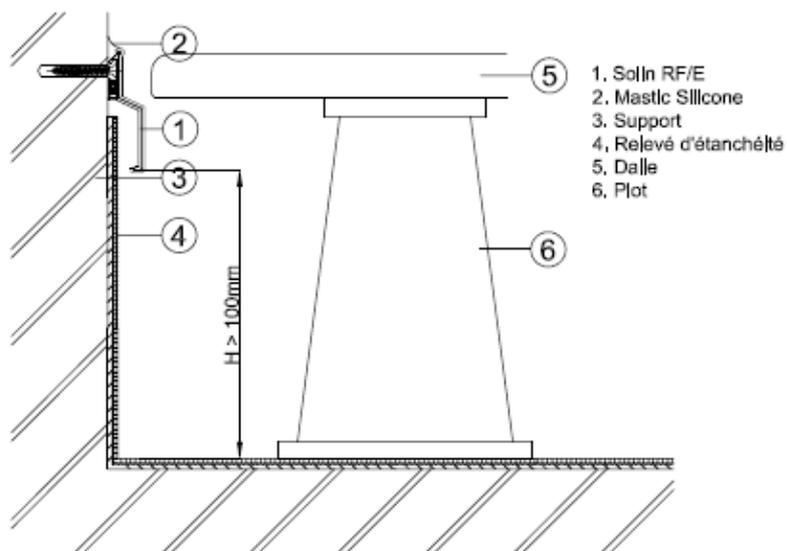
Cas de terrasses accessibles aux piétons avec protection par dalles sur plots avec ROVAL Solin RF/E avec niveau fini des dalles au-dessus du niveau fini du relevé d'étanchéité
